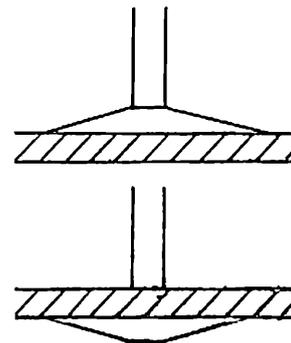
17. Возможное распределение давления на грунт при тонких плитах под несущими стенами позволяет сделать простое и экономичное армирование
